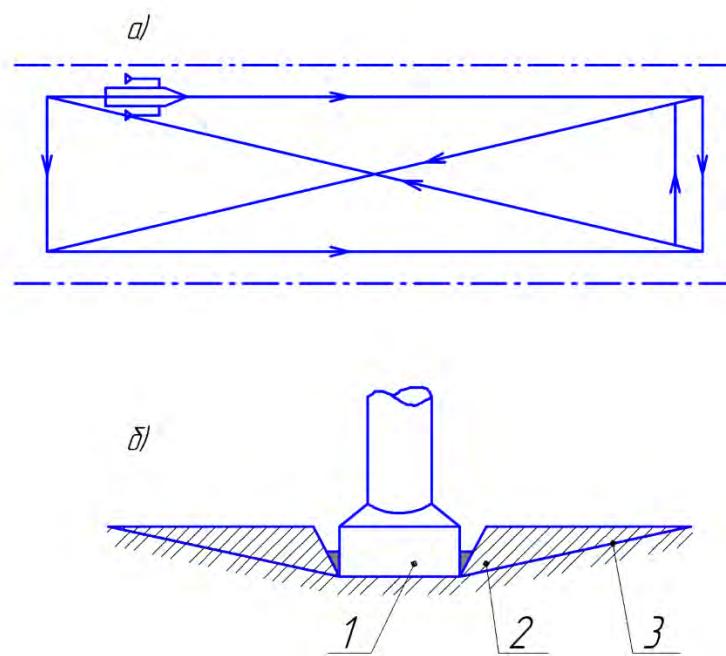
Схема разработки прорези самоотвозным землесосом на грунтах, удерживающих крутой откос: а) – схема движения землесоса; б) – схема размыва крутых откосов гидропланировщиком;
